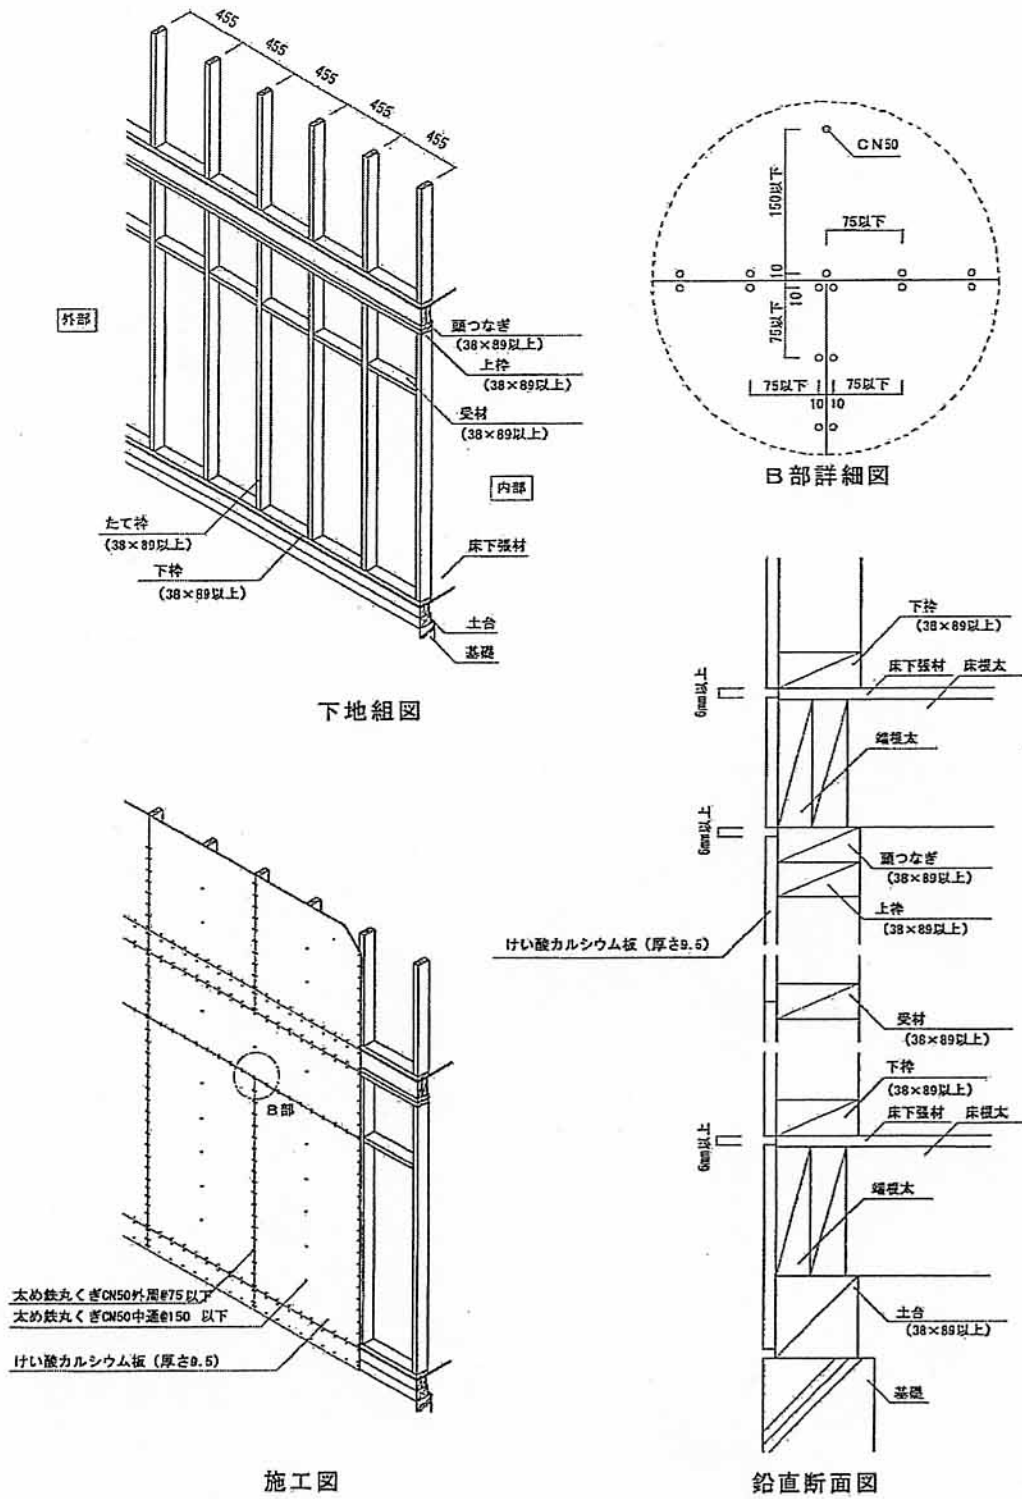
施工図：継手を設ける場合（上部横張り）（寸法単位：mm）
